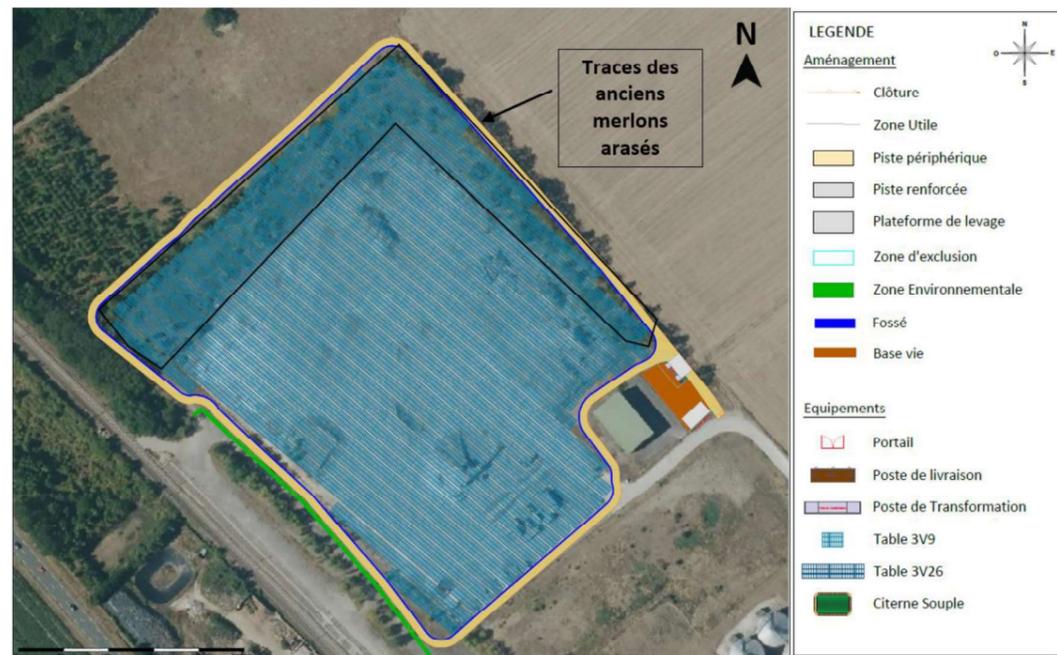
Vue en plan des implantations des structures photovoltaïques
